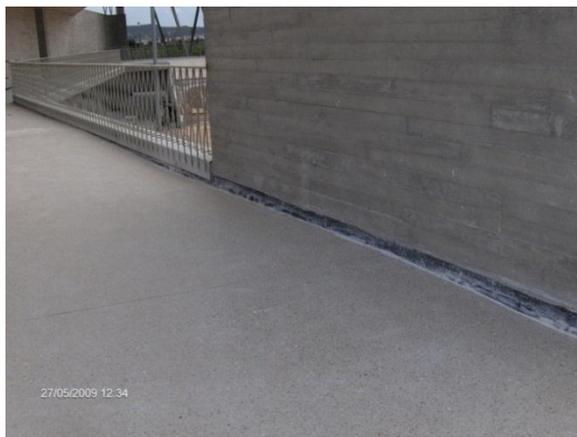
Estado de las obras. Mayo de 2009. Fuente propia
